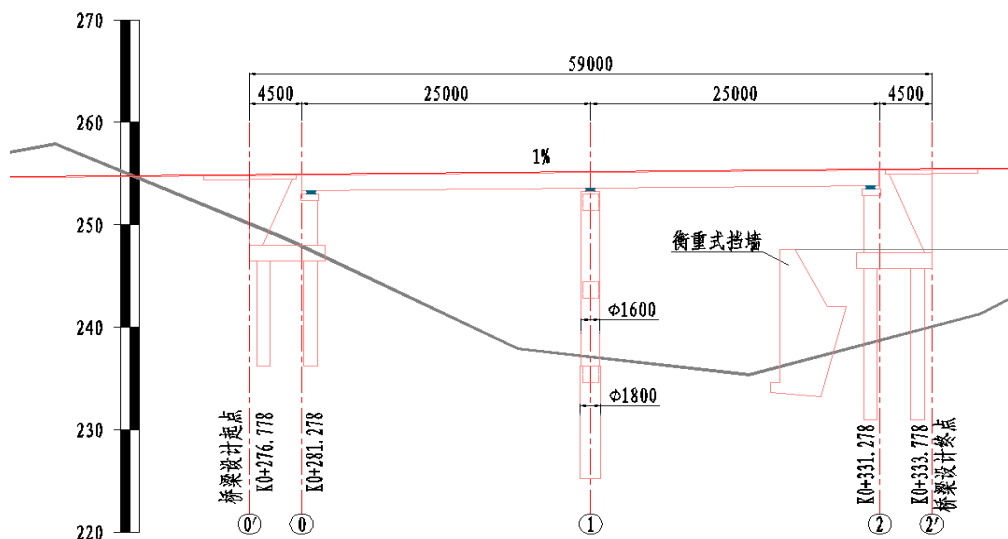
滨山大道高架桥左幅桥型布置图 (单位: mm)
